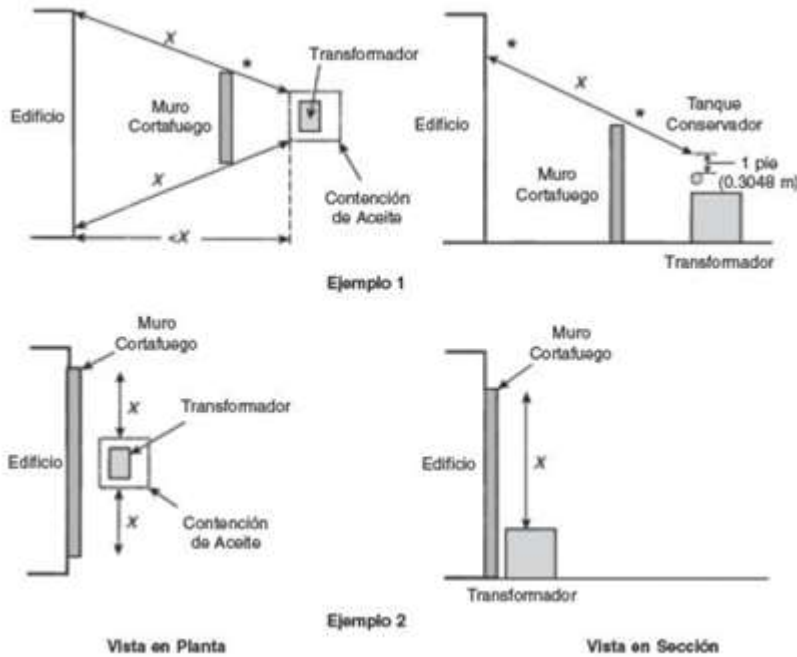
Dimensiones Geométricas diseño muro cortafuego transformador
